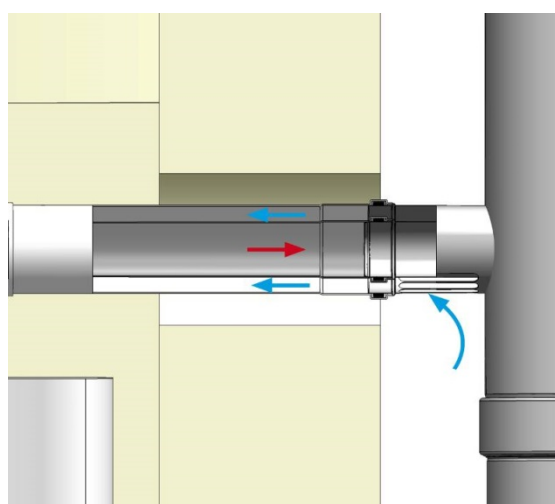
Mise en place du conduit de liaison, version DINAGAS 3CE+ DW pour utilisation à l'extérieur d'un bâtiment
